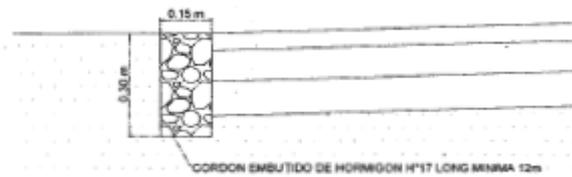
Detalle de cordón Protector de Borde de Pavimento
